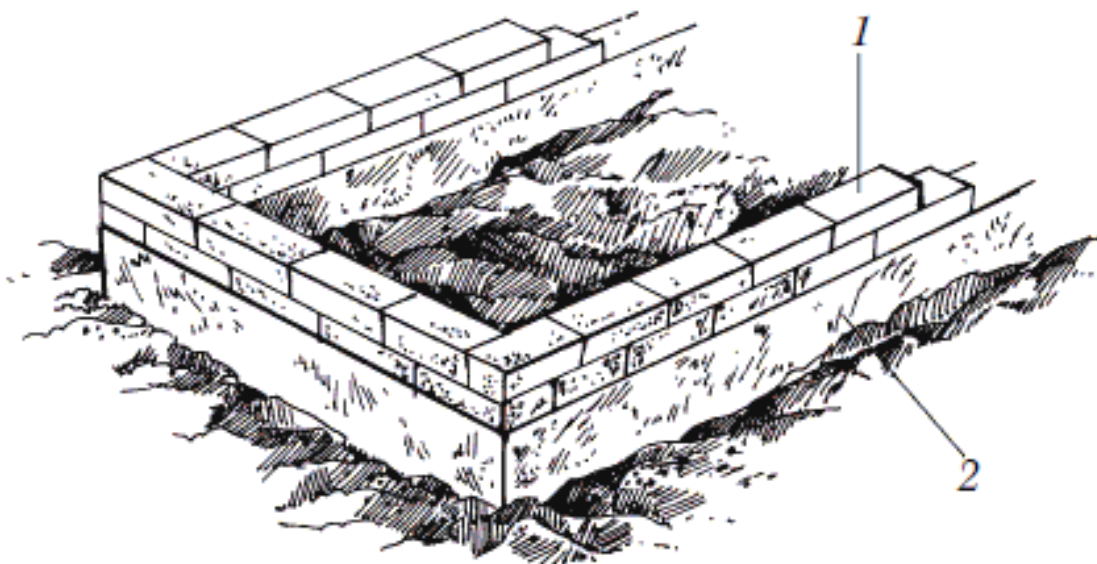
Ленточный фундамент: 1 – несущие стены здания; 2 – ленточный фундамент
